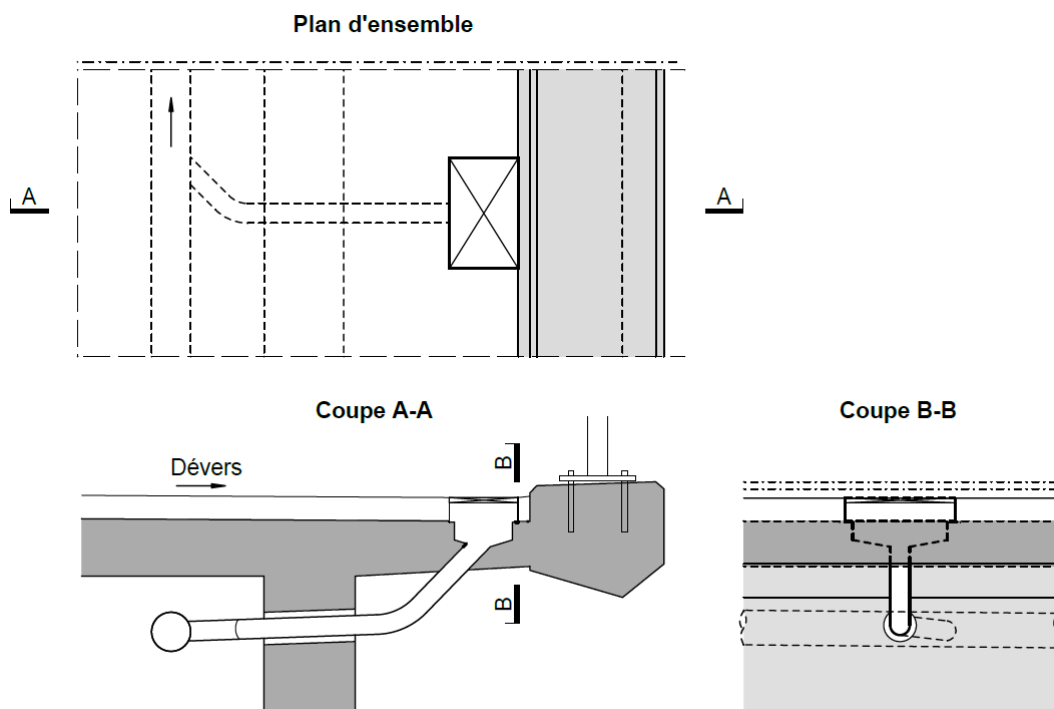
Pont à poutres avec la conduite collectrice entre les poutres
